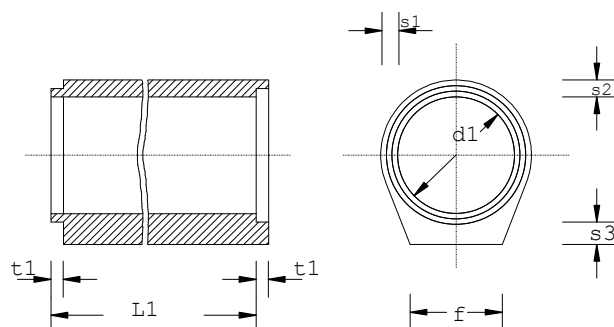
tubi in calcestruzzo di sezione circolare con giunto a risega e piede
